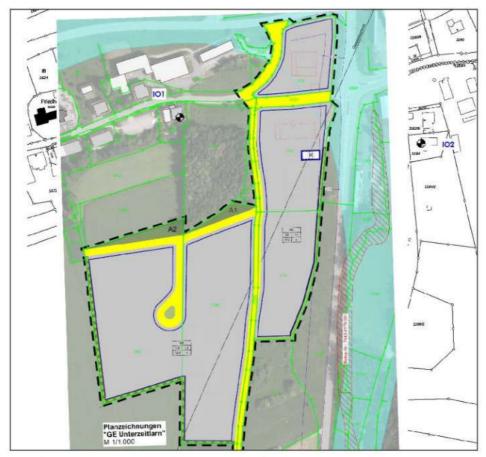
Lageplan mit Darstellung der maßgeblichen Immissionsorte (IO)
